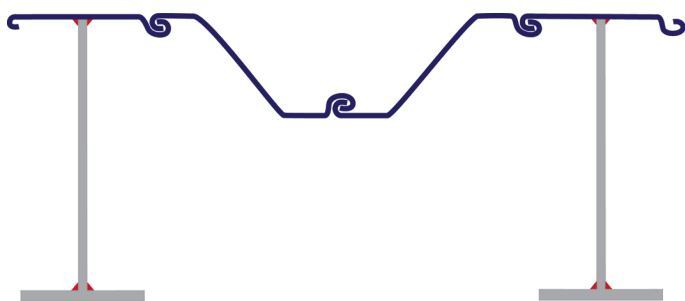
Несущая свая в виде сварного тавра с х/к ПФЗ
